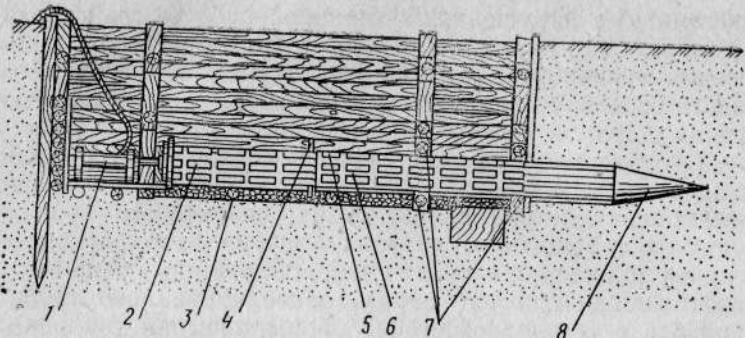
Схема установки для продавливания патрона без выемки грунта
